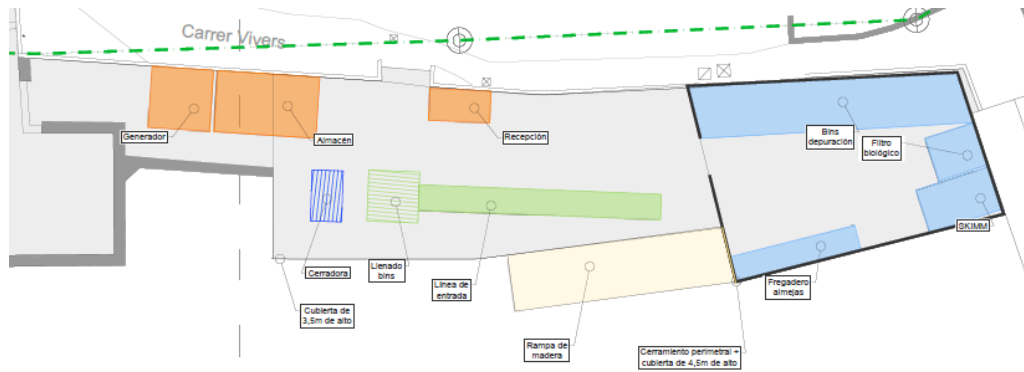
Planta propuesta para la alternativa 1 en las parcelas 8, 9 y 10.
